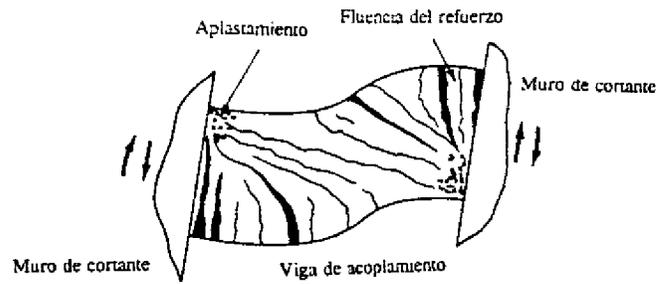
Deformación y agrietamiento de vigas de acoplamiento
